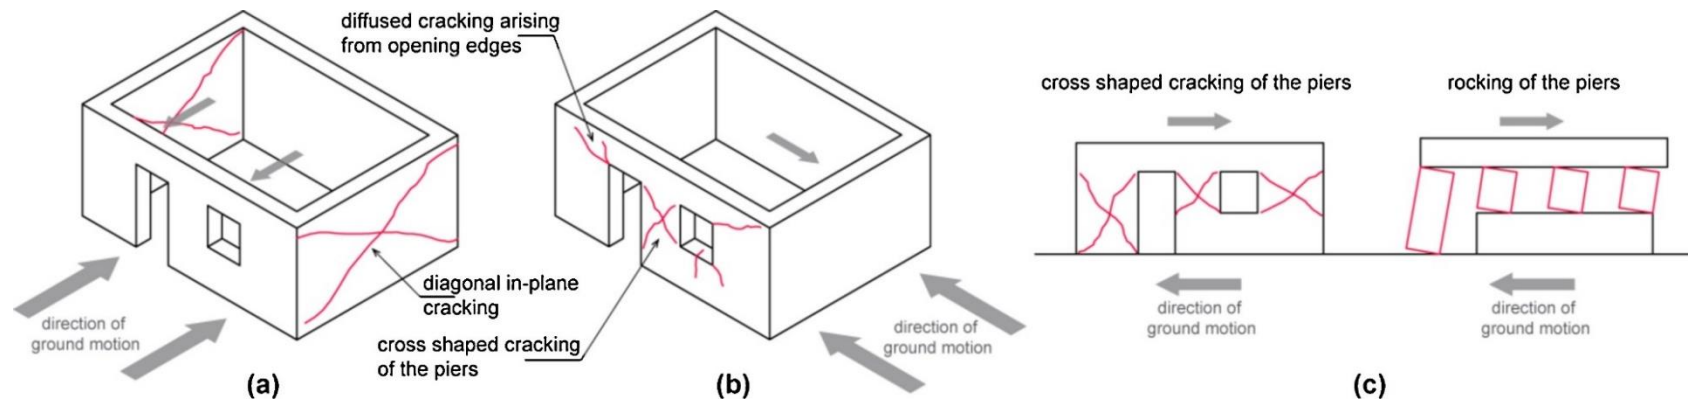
(a) Fallo de corte en el plano en la dirección de la longitud de la pared; (b) fisuración por corte alrededor de las aberturas; y (c) fisuración por corte frente al basculamiento de los pilares. Fuente: Paulo B. Lourenço.
